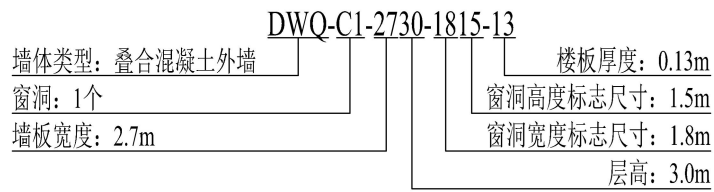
一个窗洞叠合混凝土外墙编号规则示意图
